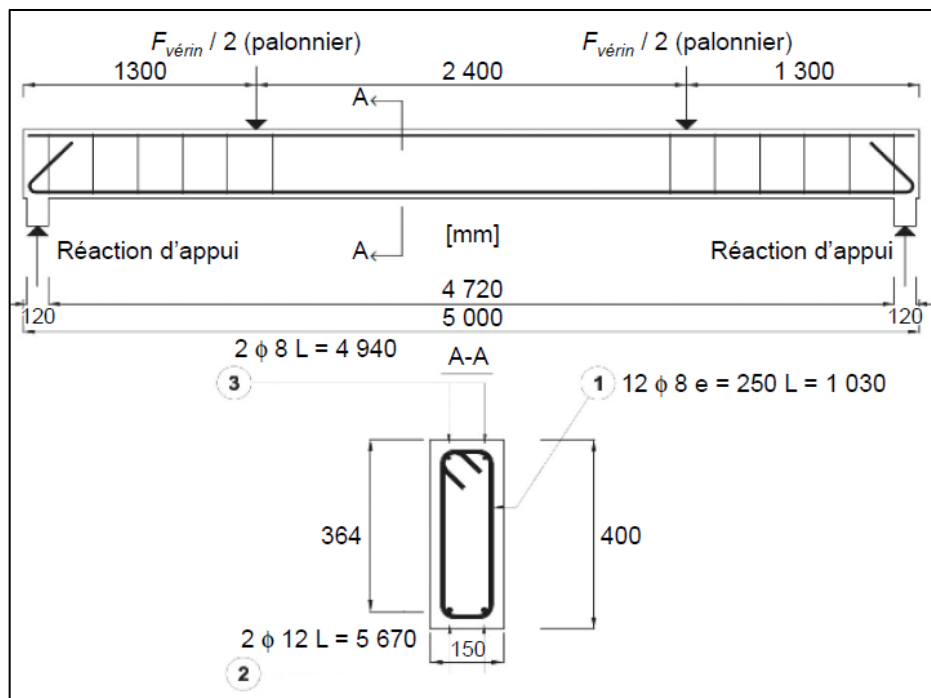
Essai de flexion 4 points et plan de ferrailage [21].
